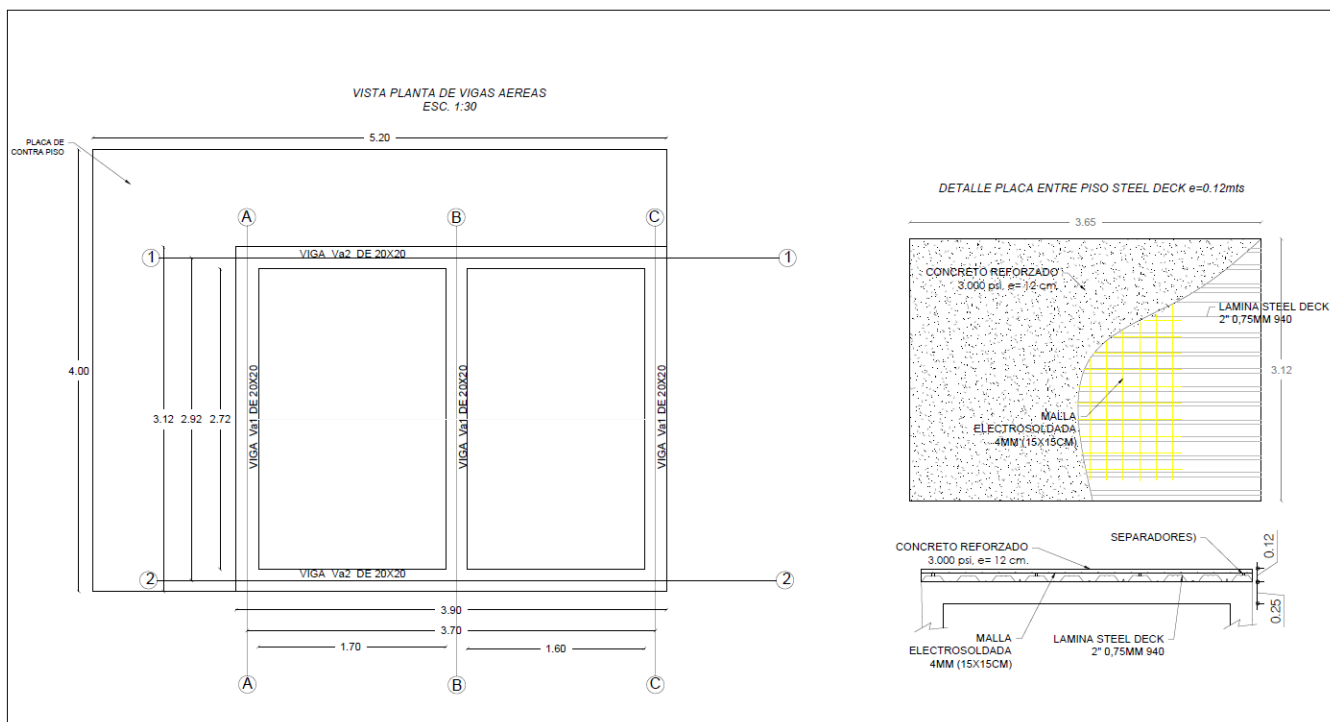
Plano vista en planta vigas aéreas y detalle placa de entre piso de batería sanitaria Casa Cabildo
